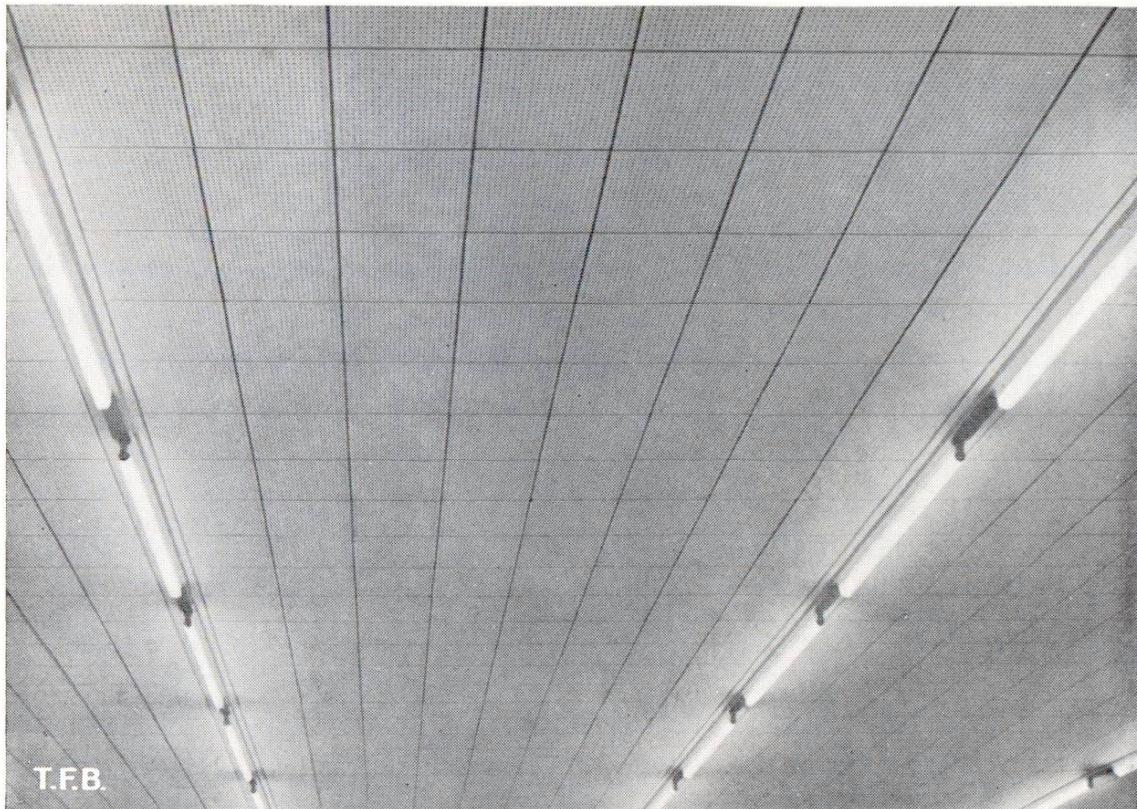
Plafond d'une salle revêtu de plaques spéciales pour l'absorption des bruits
